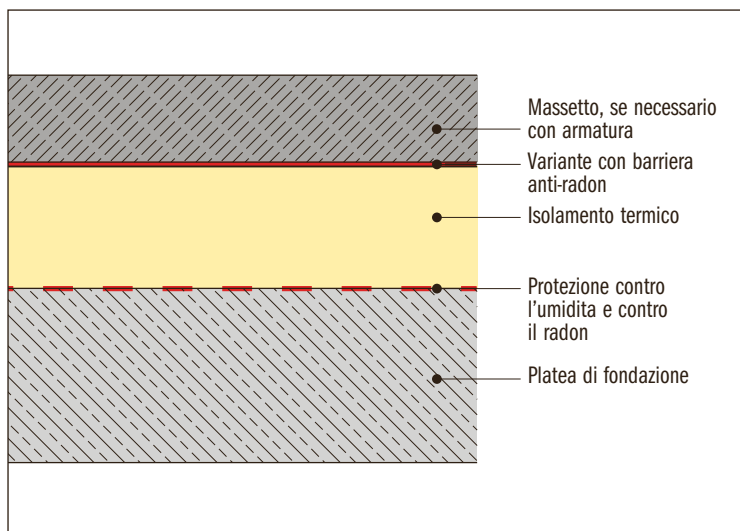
Stratigrafia pavimento classica (Fonte: Dow Building Solutions).
